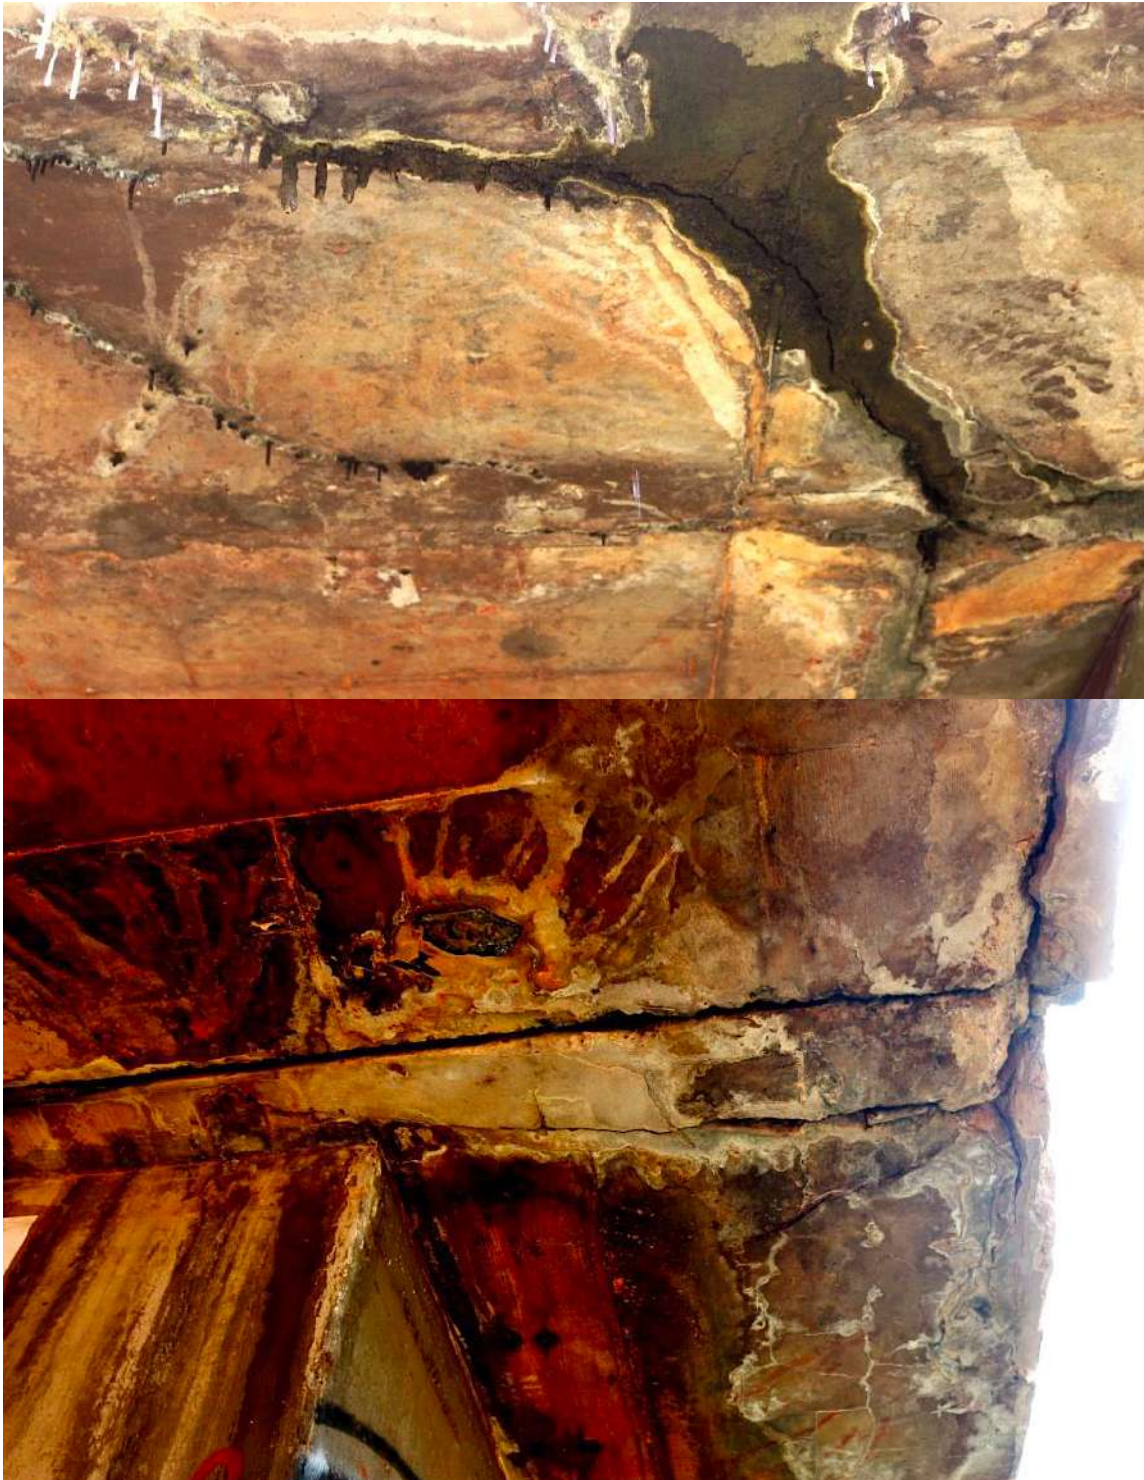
Fissuras ocasionadas pela retração do concreto. Fonte: Laudo de vistoria técnica da NOVACAP (2018)
